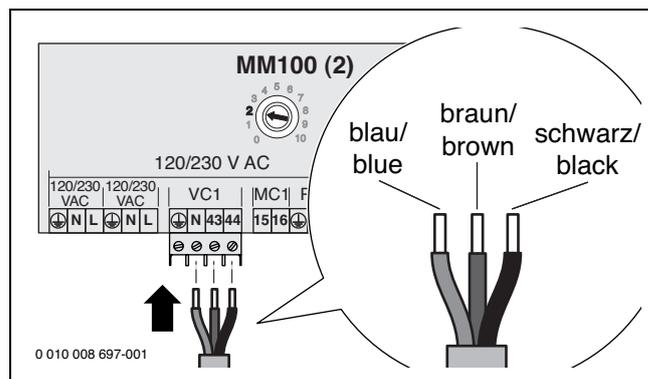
Collegamento del cavo motore valvola miscelatrice al modulo MM100 [2]
